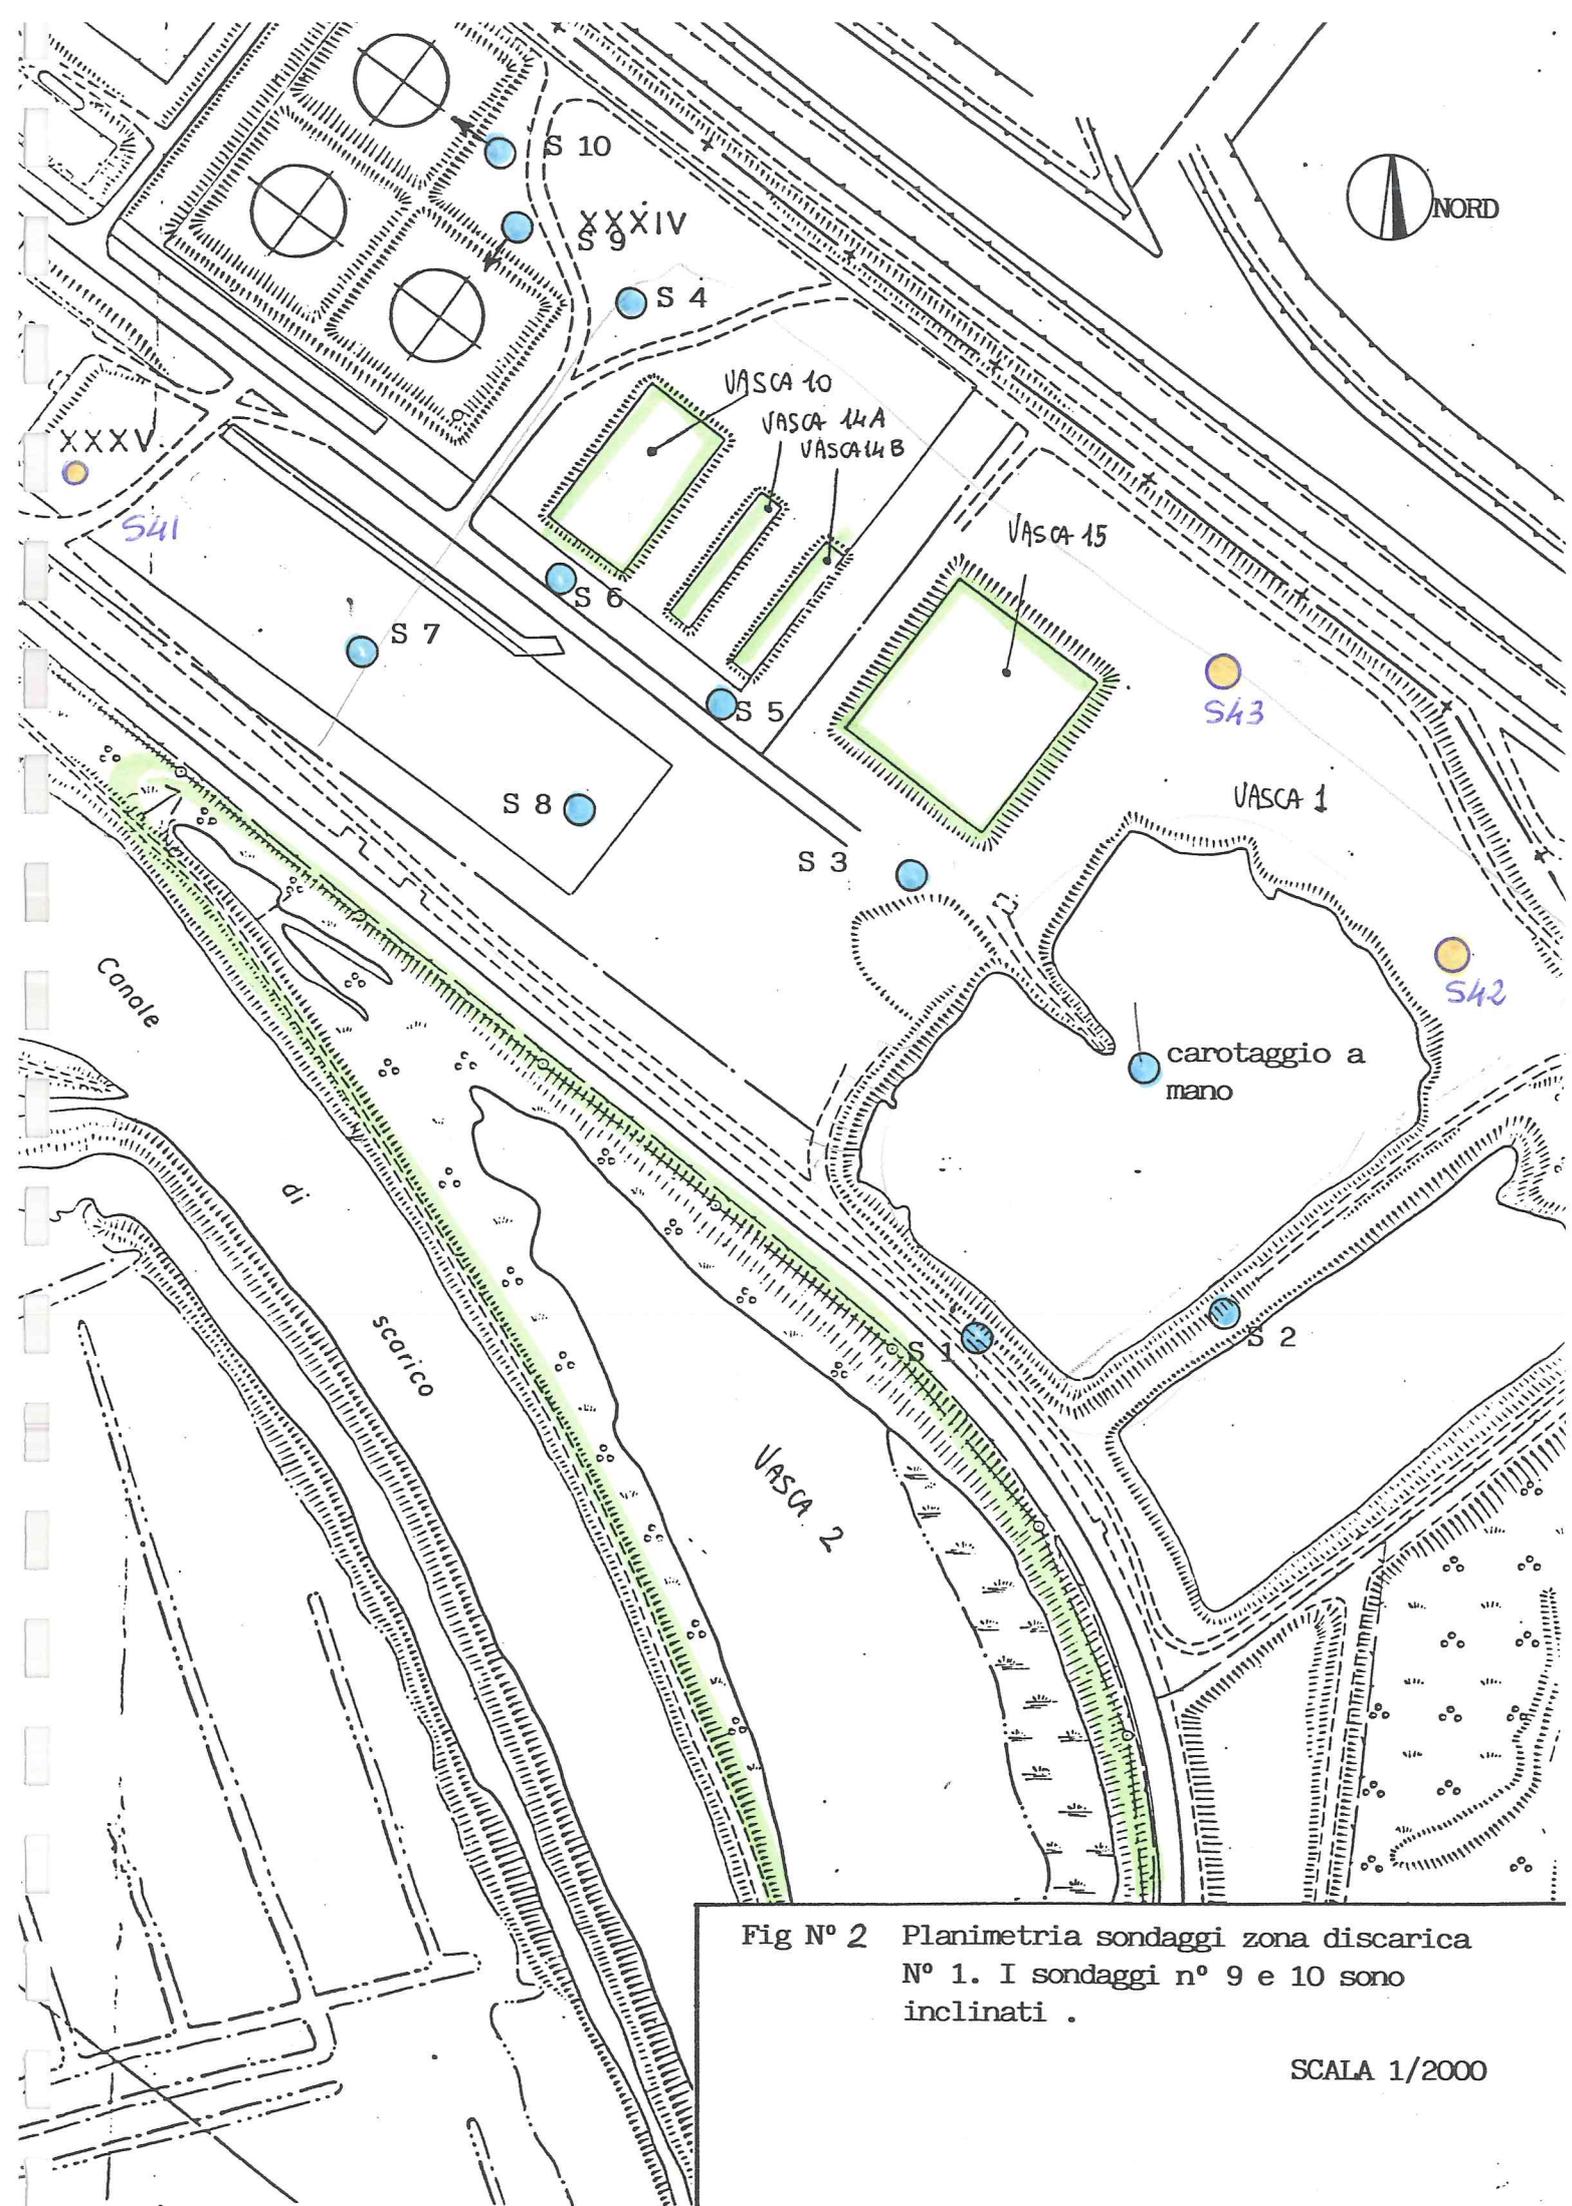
Planimetria sondaggi zona discarica N° 1. I sondaggi n° 9 e 10 sono inclinati .
